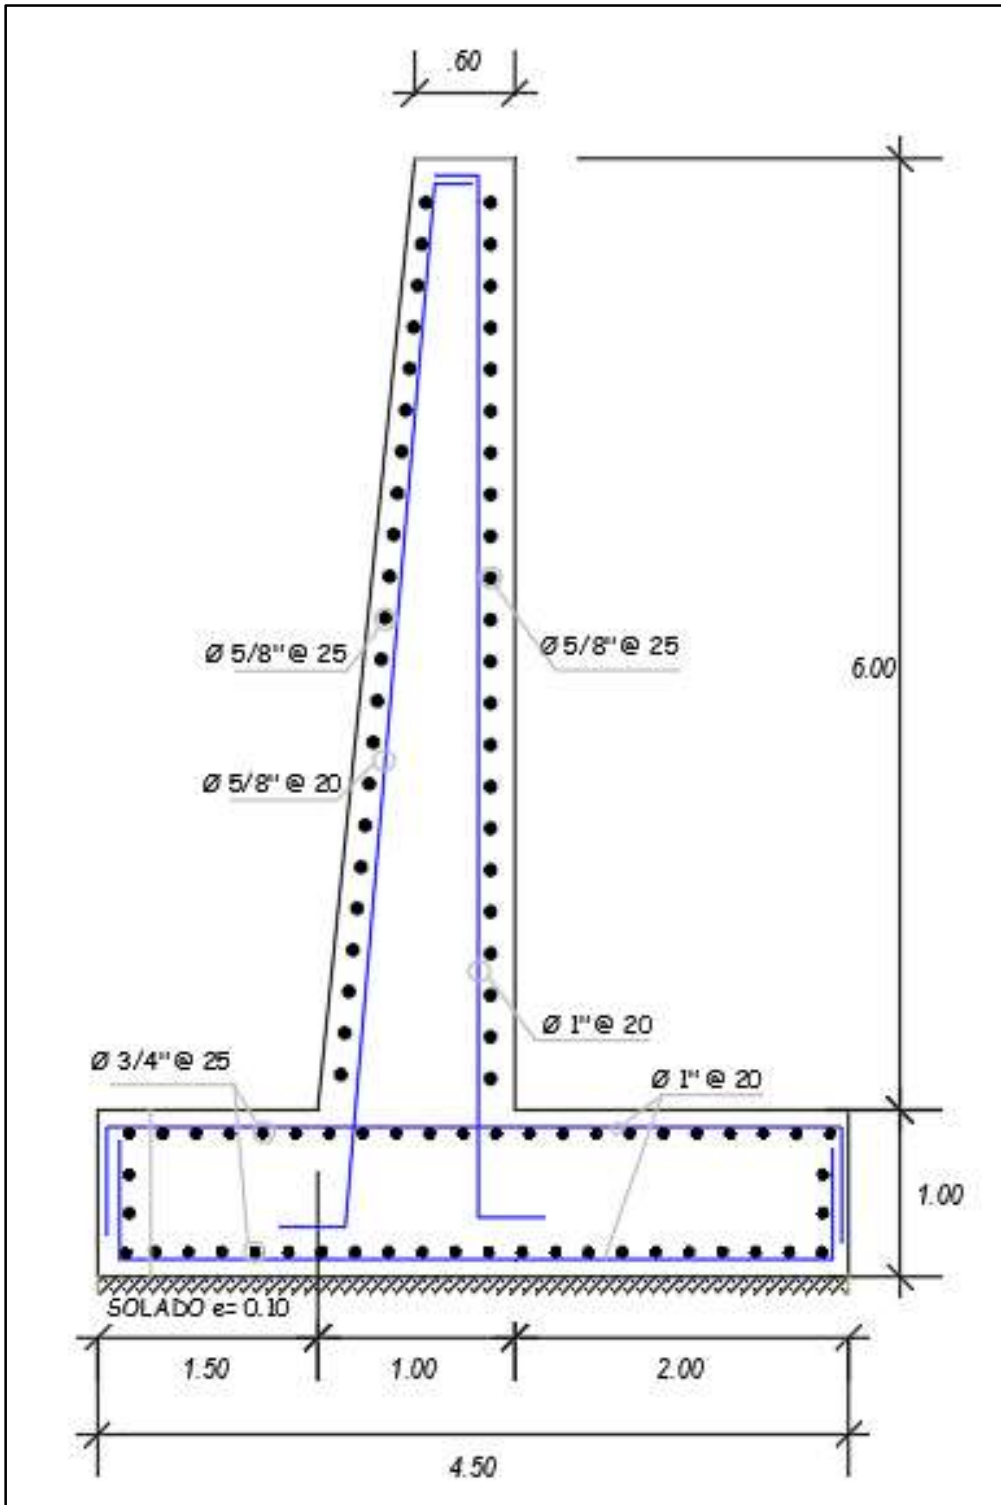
Distribución de las varillas de acero en el Muro en voladizo.
